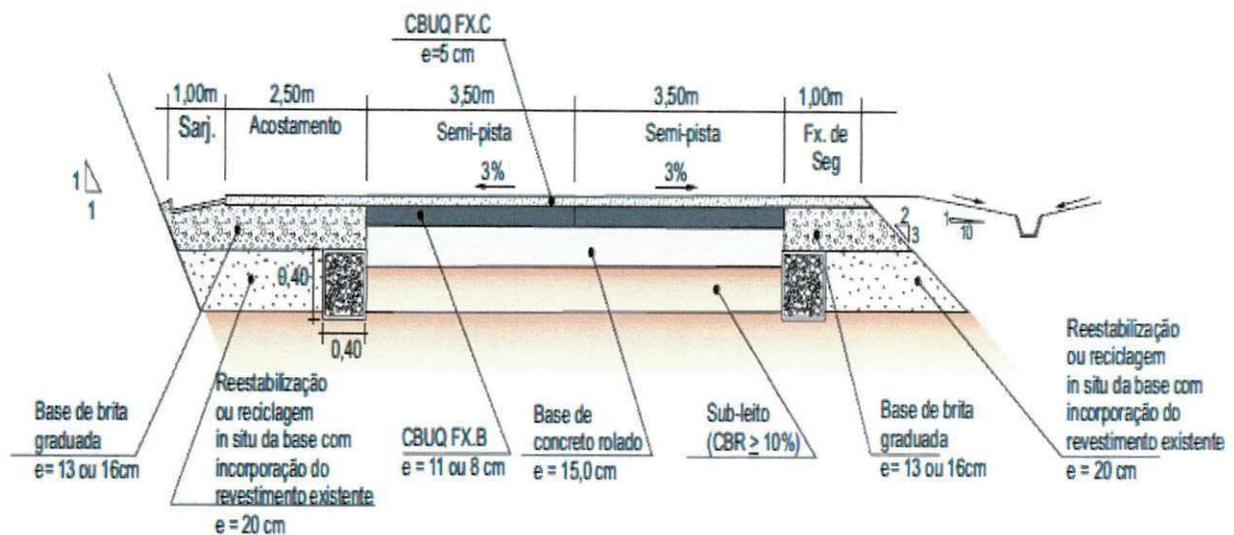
Vista de pavimento existente a ser fresado e reconstruído.
